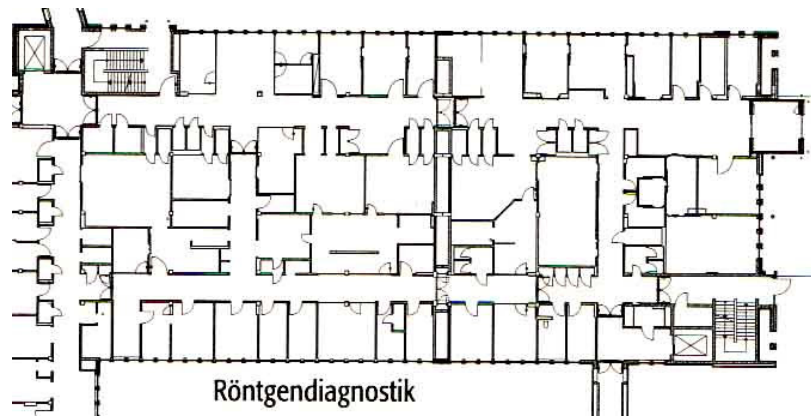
Merkez plan örneği (AIA, 1996, s.81)
